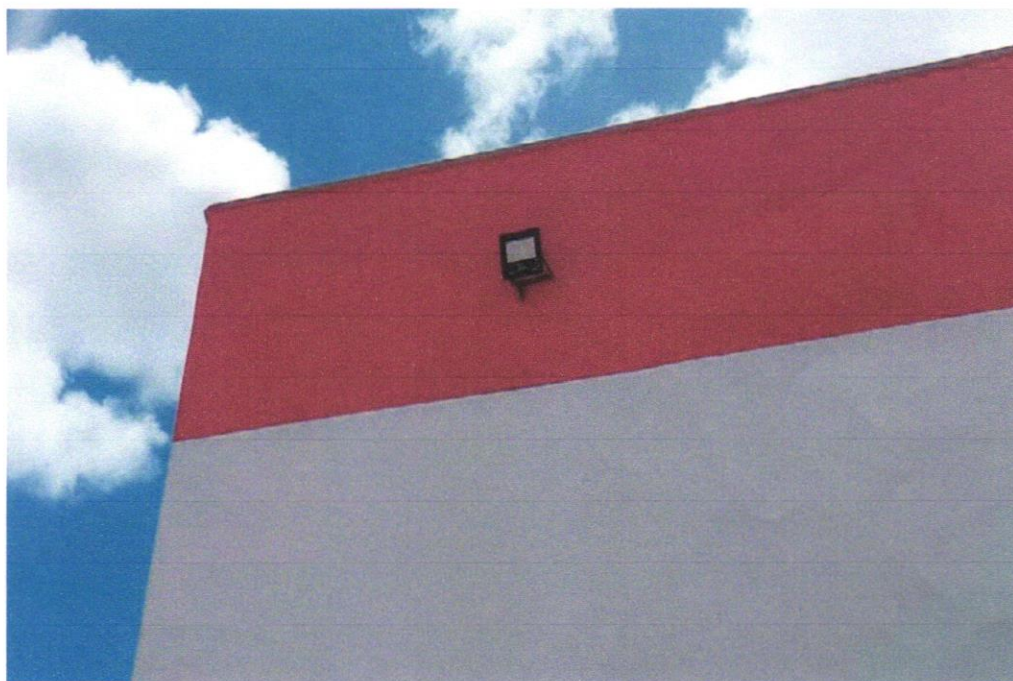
Rufo em chapa aço galvanizado nº24 com desenvolvimento 25cm
